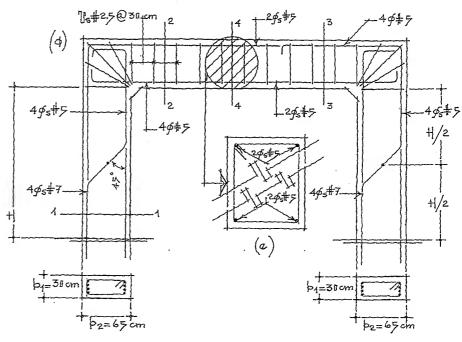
Corte transver\_ sal 1-1 y planta, (b).
